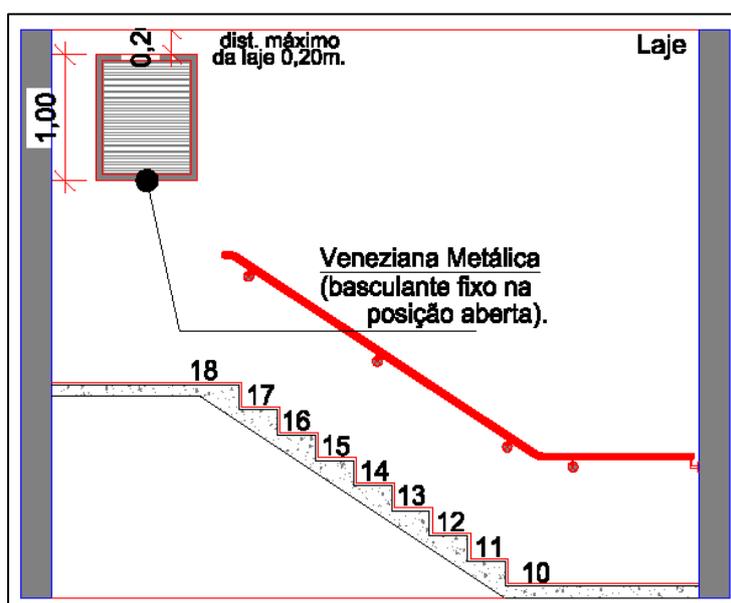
Corte da ventilação da escada protegida (demais pavimento)
